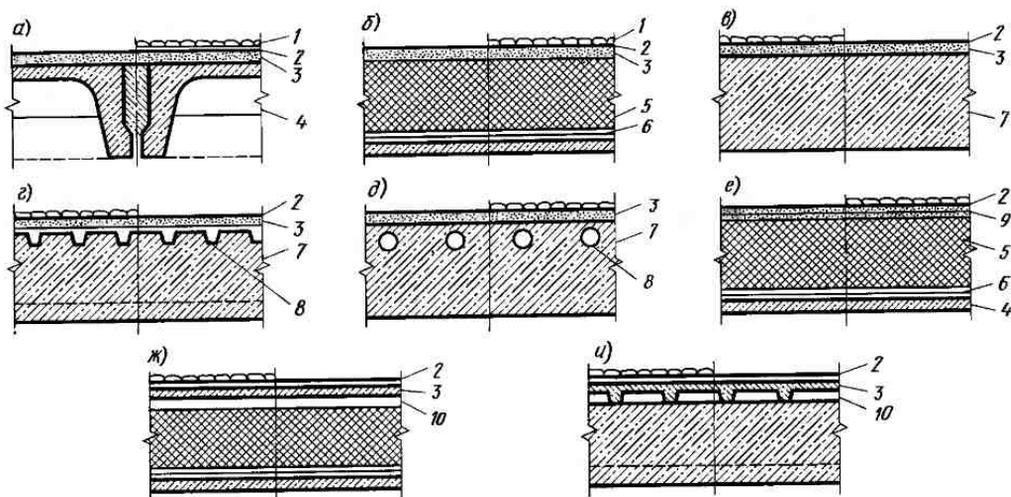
Основные типы покрытий с железобетонными плитами и рулонными кровлями: а-в – неветилируемые, г, д – частично ветилируемые, е-и – ветилируемые, 1 – защитный слой, 2 – водоизоляционный ковер, 3 – стяжка, 4 – несущая плита, 5 – утеплитель, 6 – пароизоляция, 7 – комплексная плита, 8 – каналы и борозды, 9 – перфорированный рубероид с гравием, 10 – воздушная прослойка
